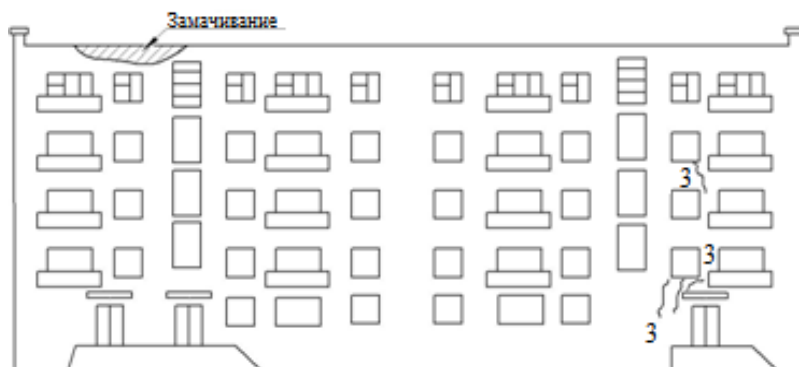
Дом 49. Трещины стены дворового фасада
